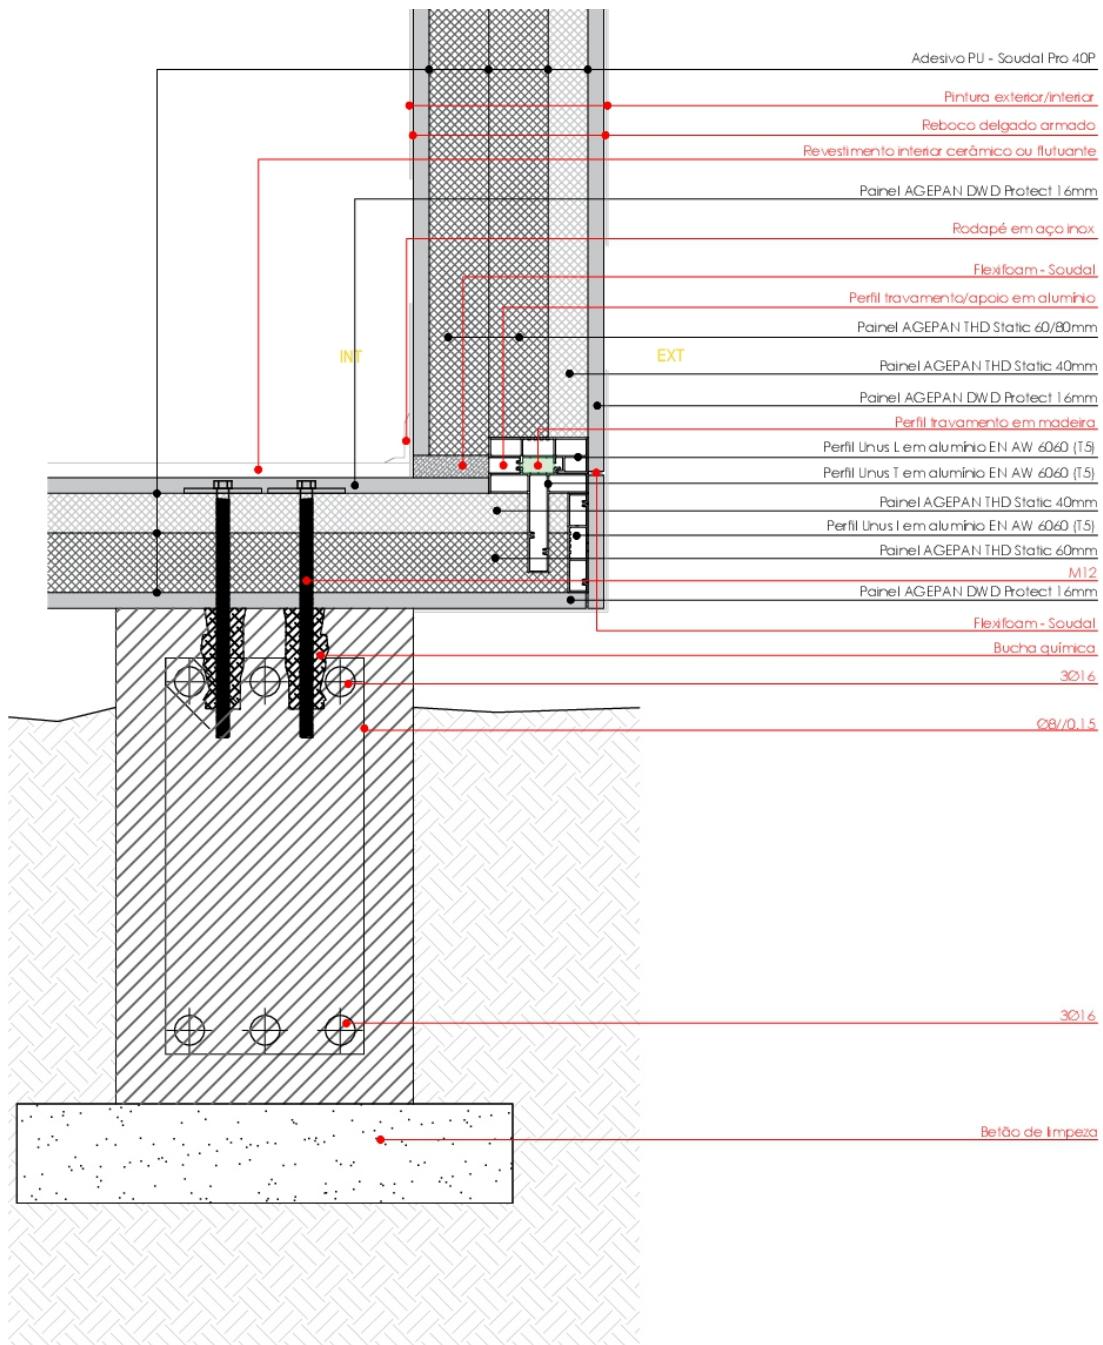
Solução AGEPAN – Pormenor Construtivo de Pisos/ Paredes I.
